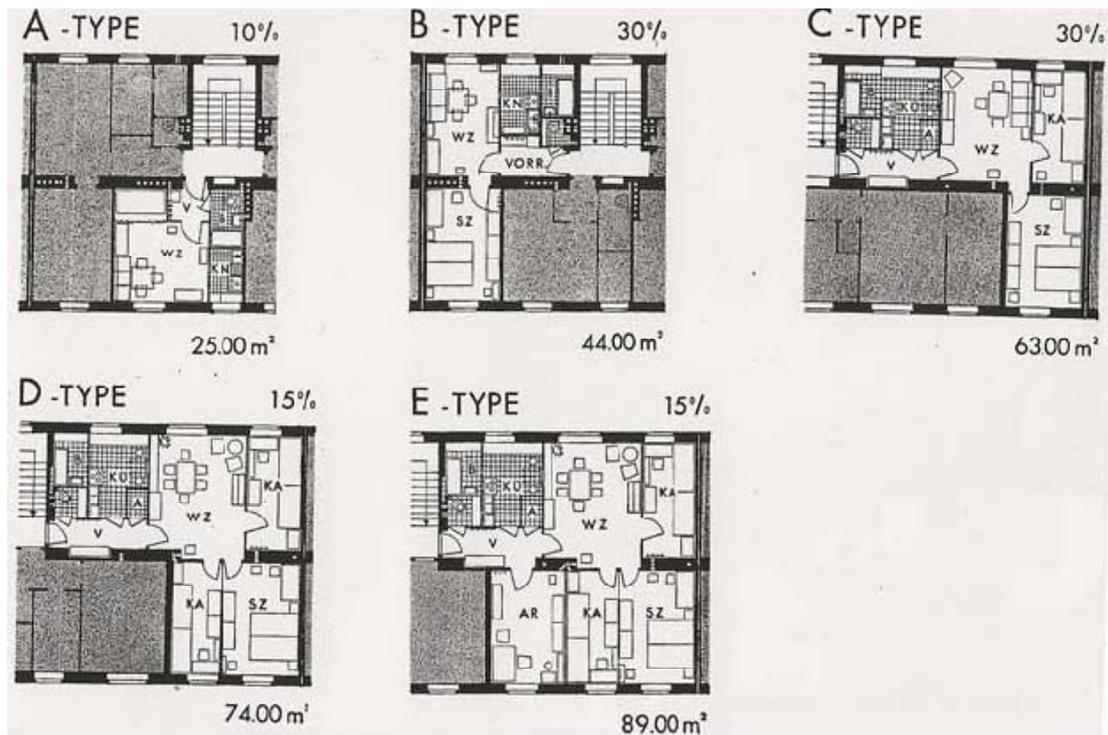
Typengrundriss im sozialen Wohnbau 1956 (Quelle: Stadt Wien 1956, Der Soziale Wohnungsbau der Stadt Wien S.57)
